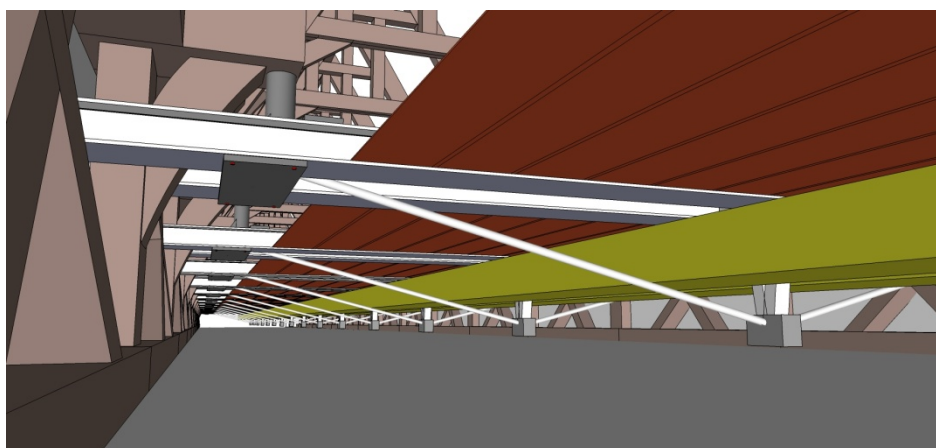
L'agencement dans l'espace des poutres, des barreaux, des tirants, du coffrage de la dalle et des gains de ventilation.
